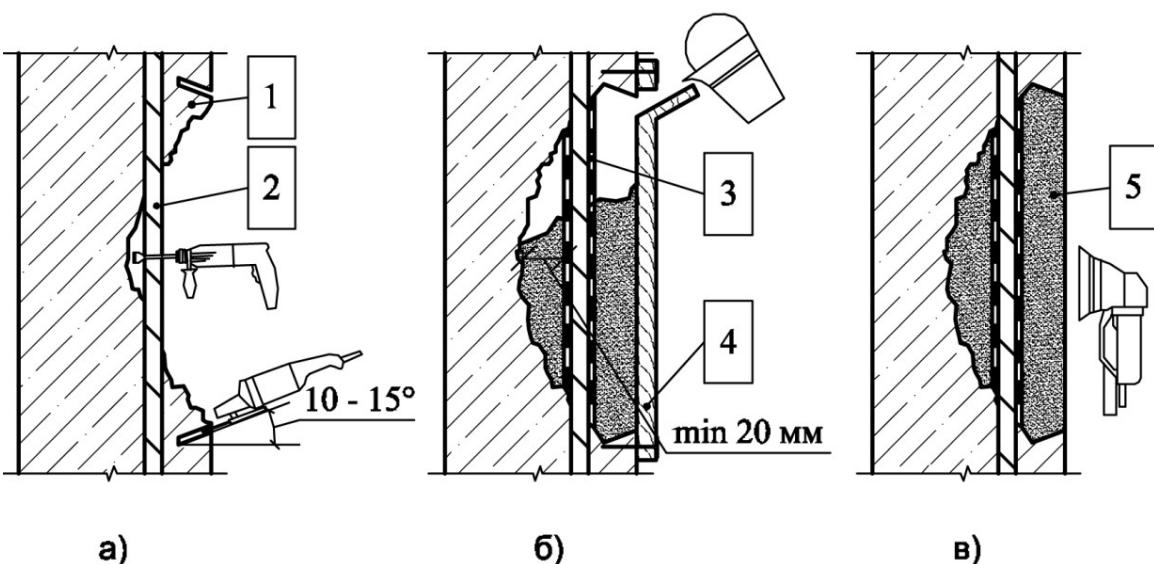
Схема ремонта дефектов бетона с оголением арматуры:
